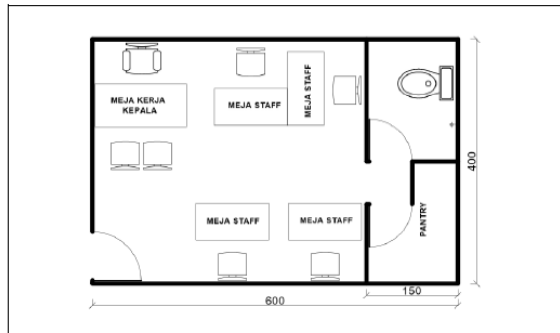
15 Tipikal Denah Ruang Wakil Kepala Stasiun
